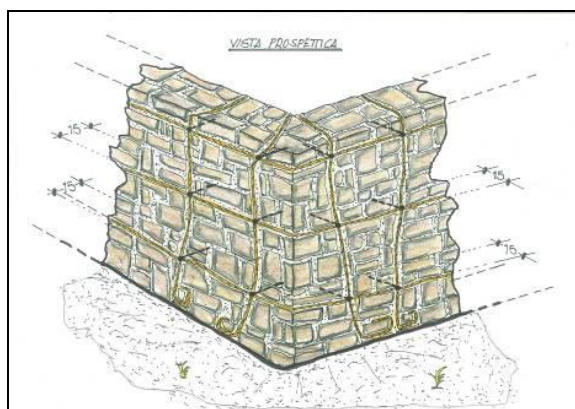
La continuità dei trefoli contribuisce al collegamento tra gli elementi murari.
